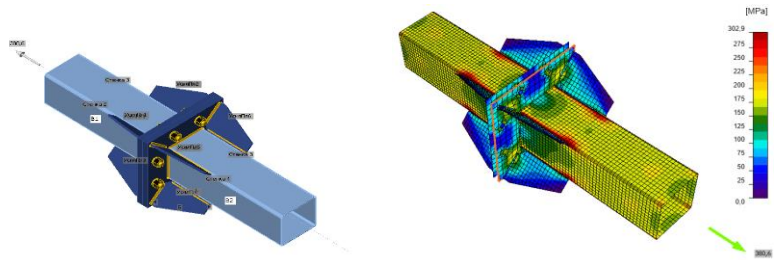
Расчётная схема и эквивалентные напряжения монтажного узла нижнего пояса стропильной фермы
